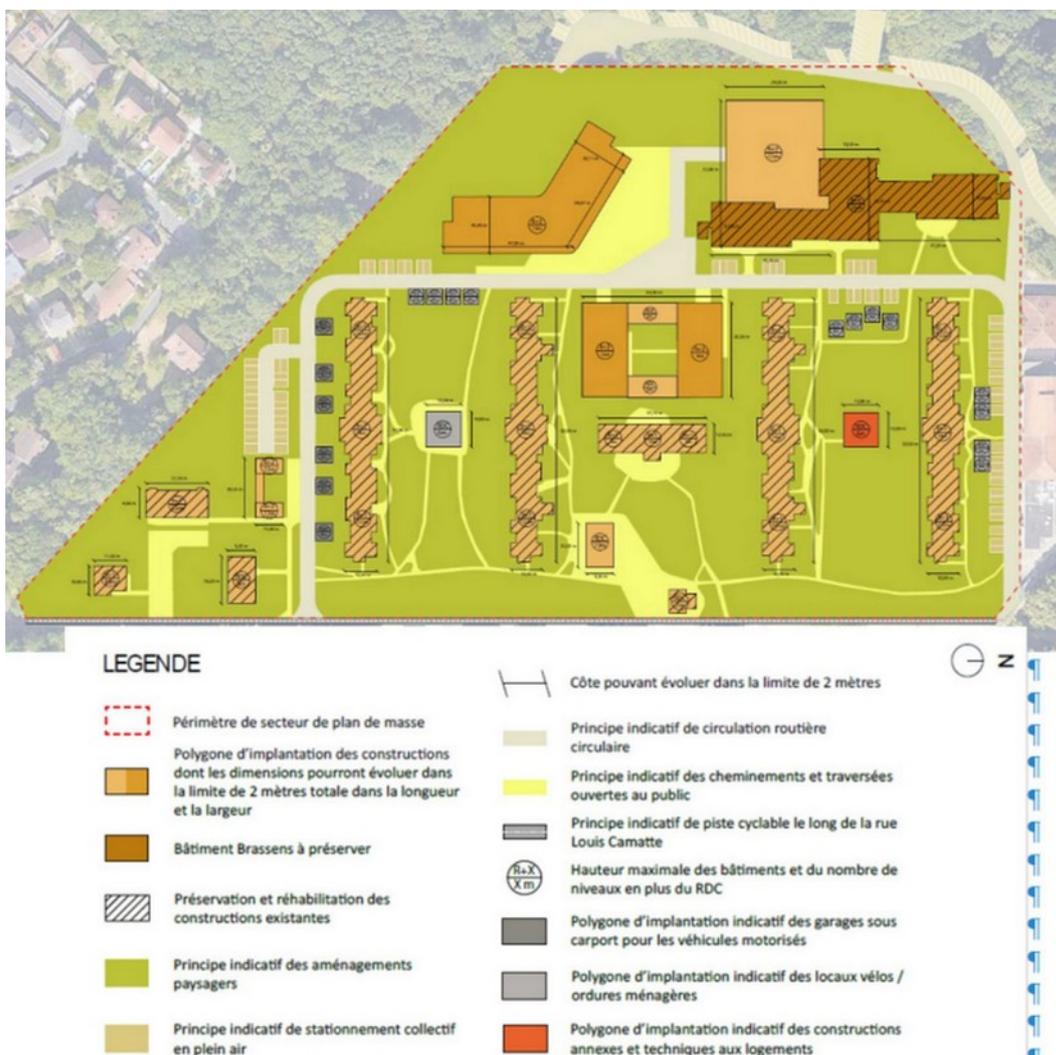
Plan de masse fixant les principes du projet sur le secteur (RP p.40).
